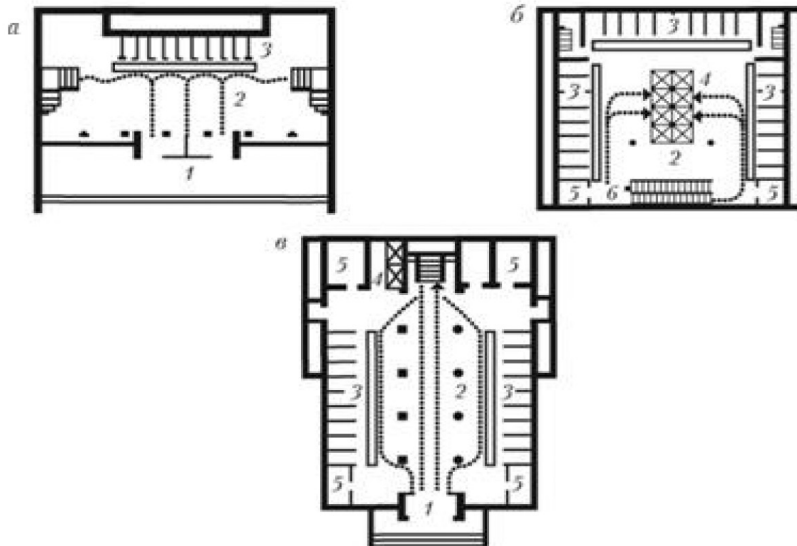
Планувальні схеми вестибюлів у громадських будівлях:
